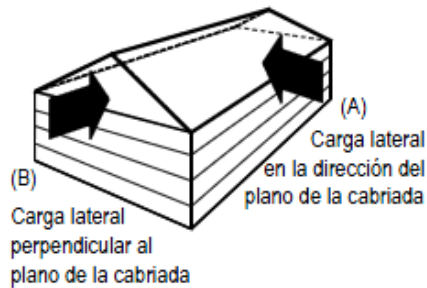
Carga lateral al plano de la cabriada. (ConsulSteel, 2002).
